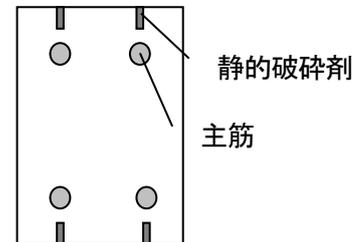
静的破砕剤による ASR ひび割れ模擬
